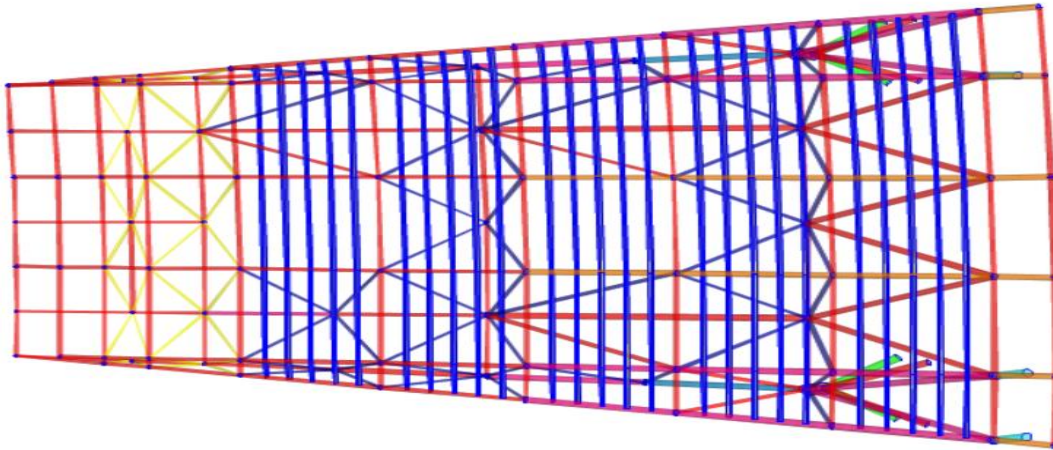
vue en Plan du model d'une structure spatiale secondaire
